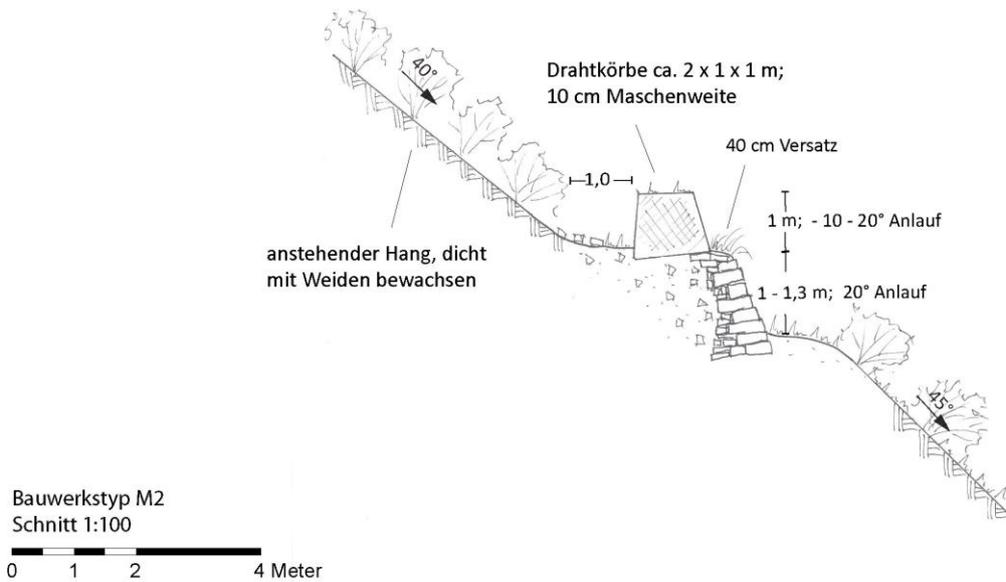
Schnitt durch den Bauwerkstyp M2
